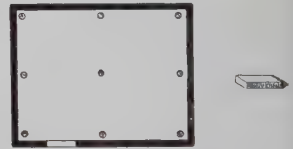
Gerüst einer Tembe, Grundriss und Form der Luftziegel.
